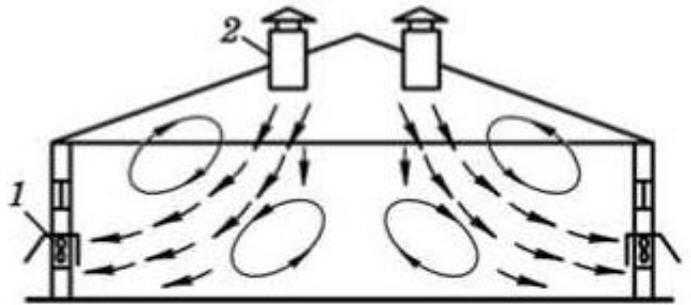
Вытяжная вентиляция помещений с настенными вентиляторами:
